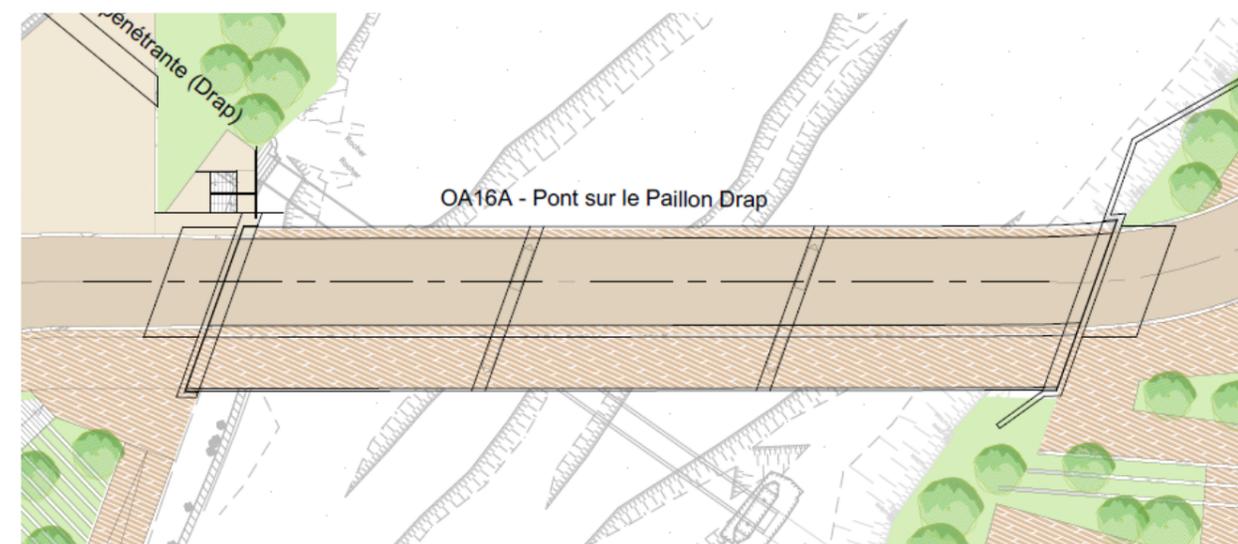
Aménagement du nouvel ouvrage au droit du pont sur le Paillon à Drap
